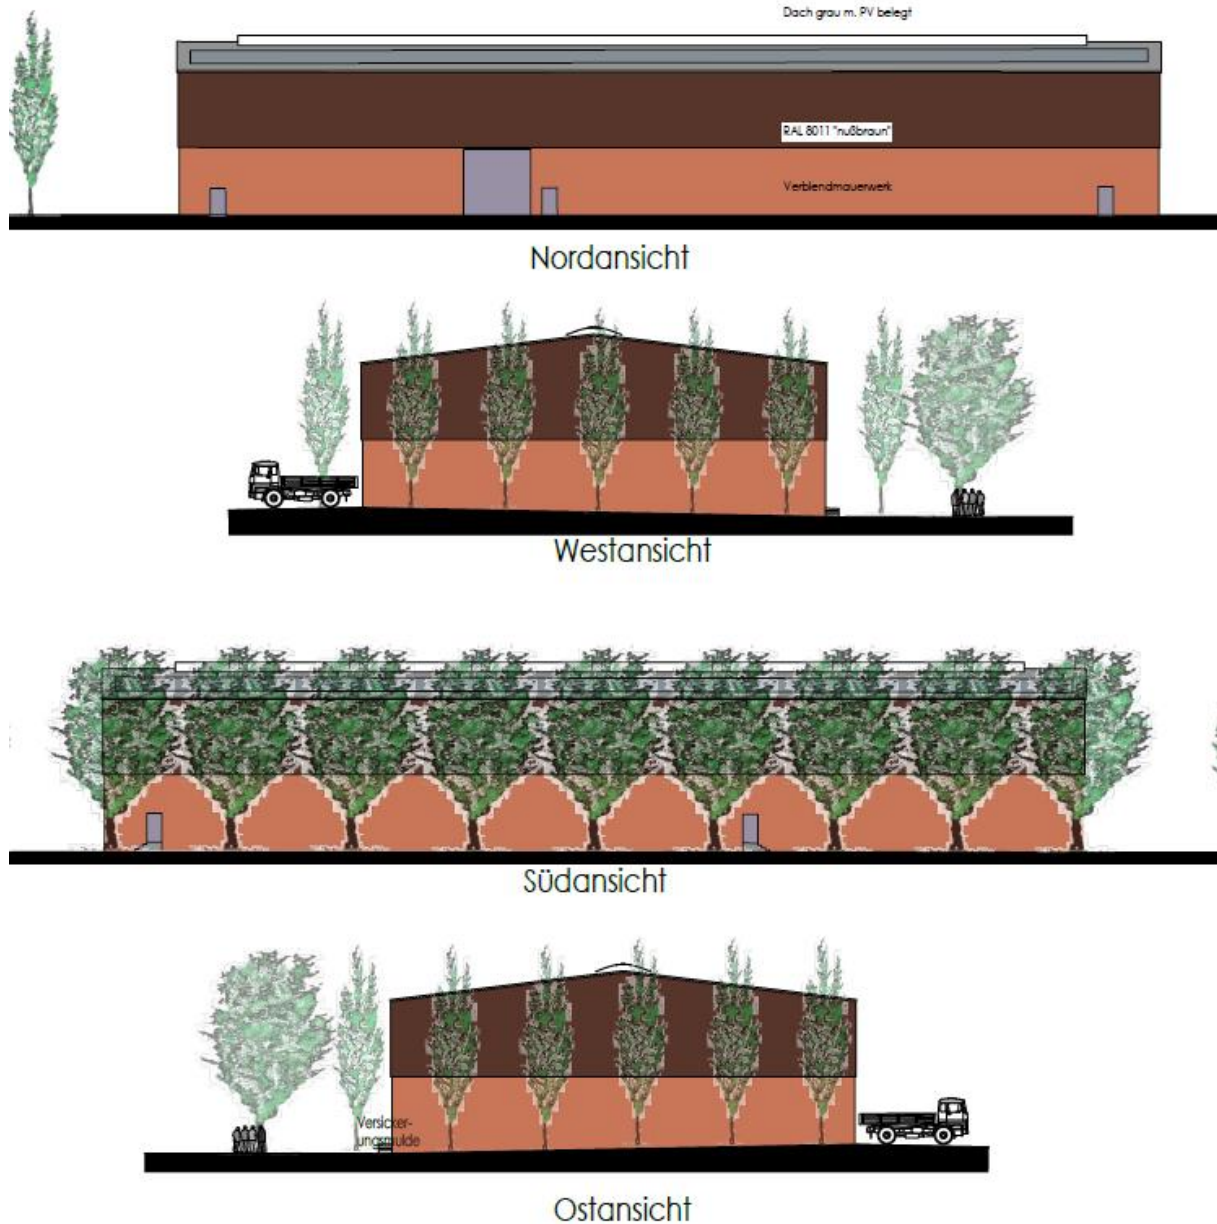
Lager- / Logistikhalle mit Erläuterungen
